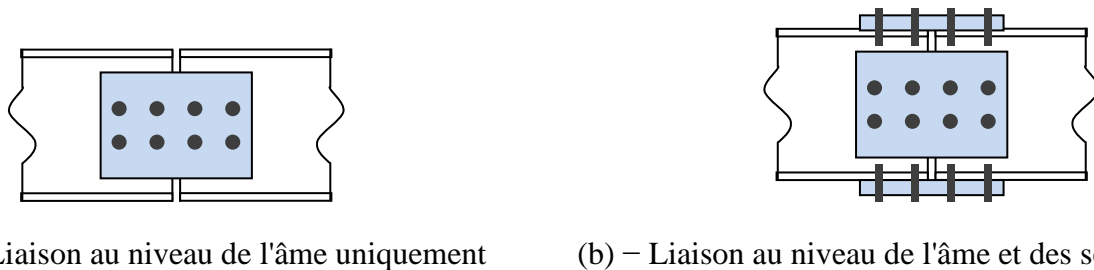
Assemblage par couvre joint ou éclissage.
